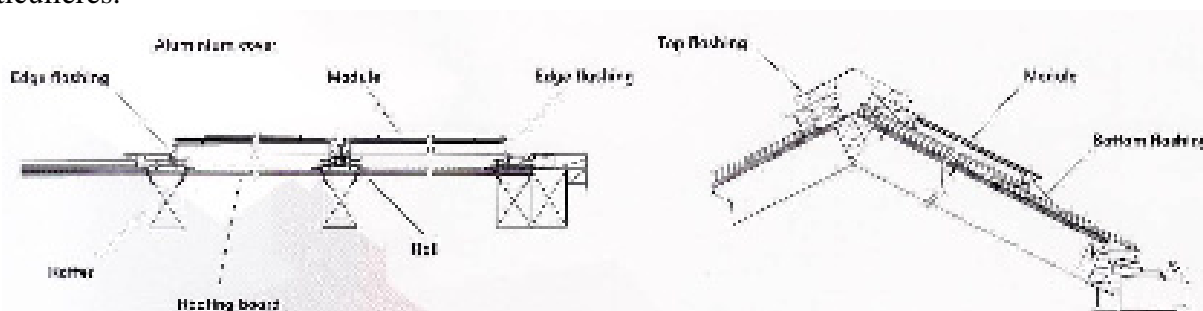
Détails de l'étanchéité en haut, bas du toit et sur les côtés
